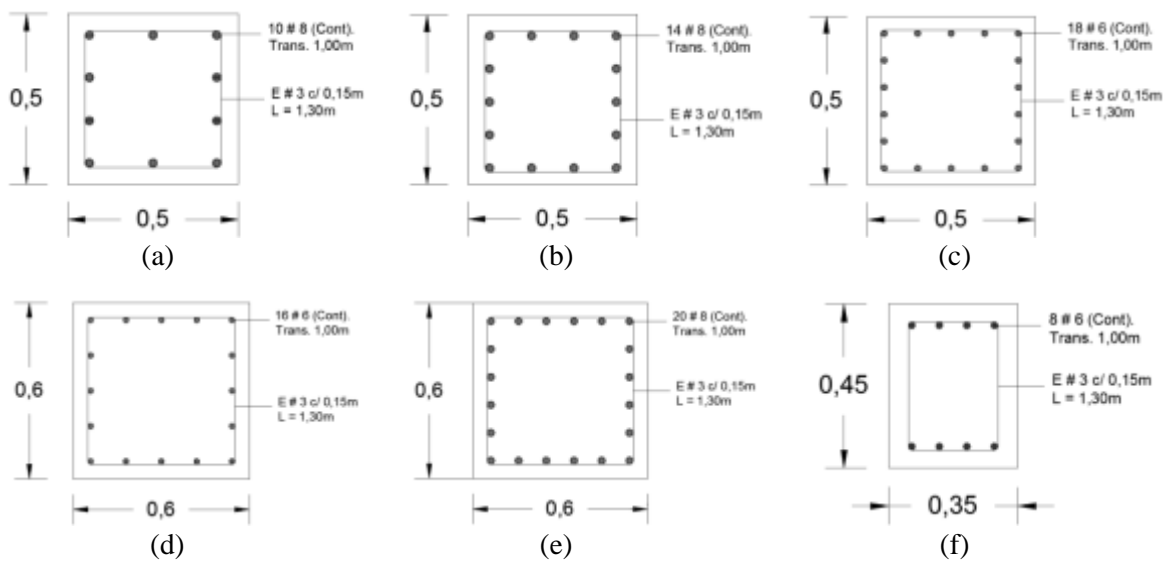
Seção transversal dos elementos estruturais. Unidades em m.
